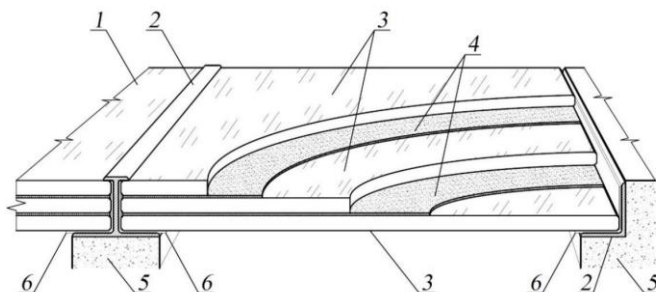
Конструкция настила (плиты) из многослойного стекла, шарнирноопертого по двум сторонам 1 – многослойное стекло; 2 – фиксирующий опорный профиль; 3 – гладкое листовое стекло; 4 – промежуточный слой; 5 – опора; 6 – упругая прокладка, герметик
